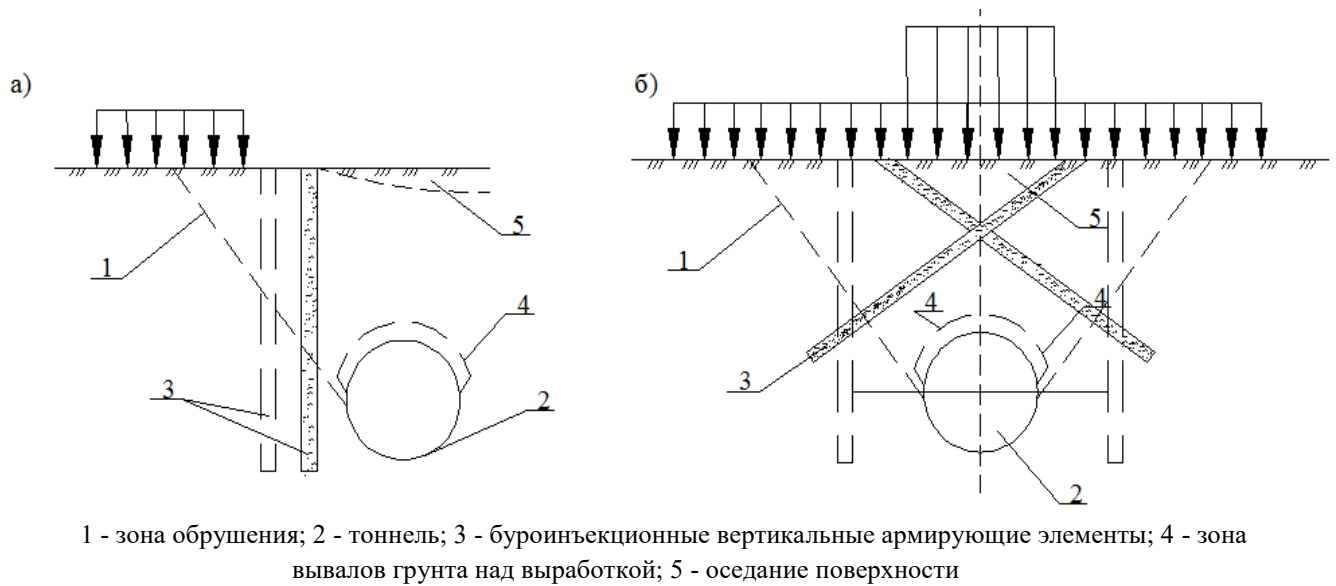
Армирование грунтового массива буроинъекционными вертикальными армирующими элементами в зонах обрушения при устройстве:
